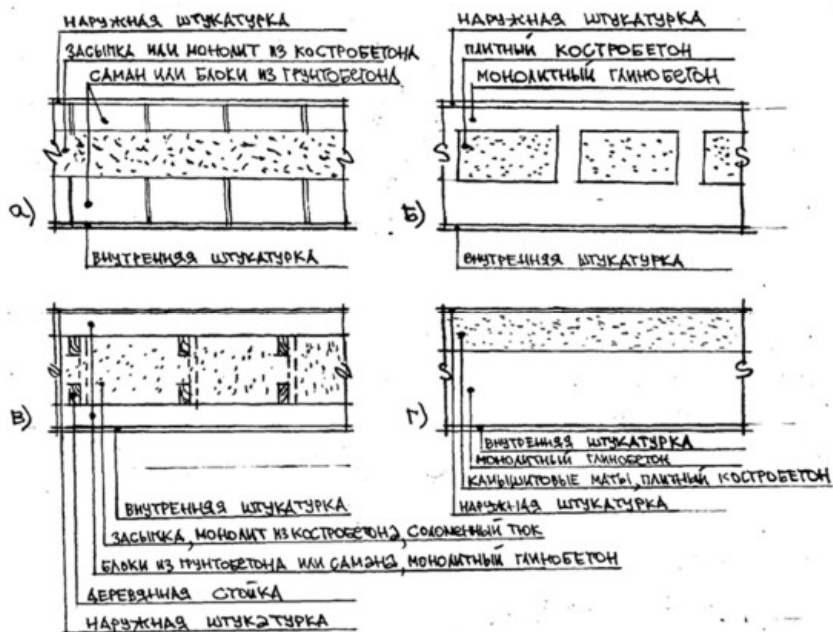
Конструкції стін екобудівель: а) з блоків і утеплювача з засипки або монолітного костробетону; б) з монолітного глинобетону і кладшівів з плитного костробетону; в) із застосуванням дерев'яного каркаса; г) з монолітного глинобетону і утеплювача з комшистових мат або плитного костробетона
